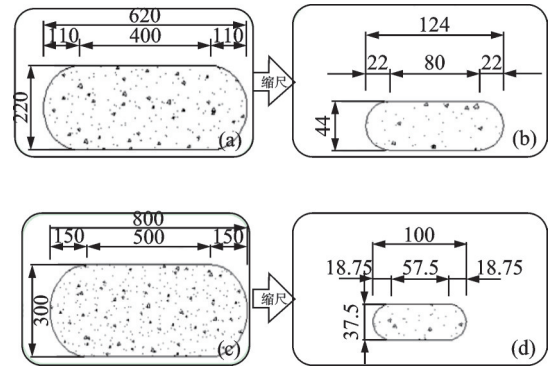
圆端矩形截面钢筋混凝土实体桥墩原型和试验模型的截面图(单位:cm)
